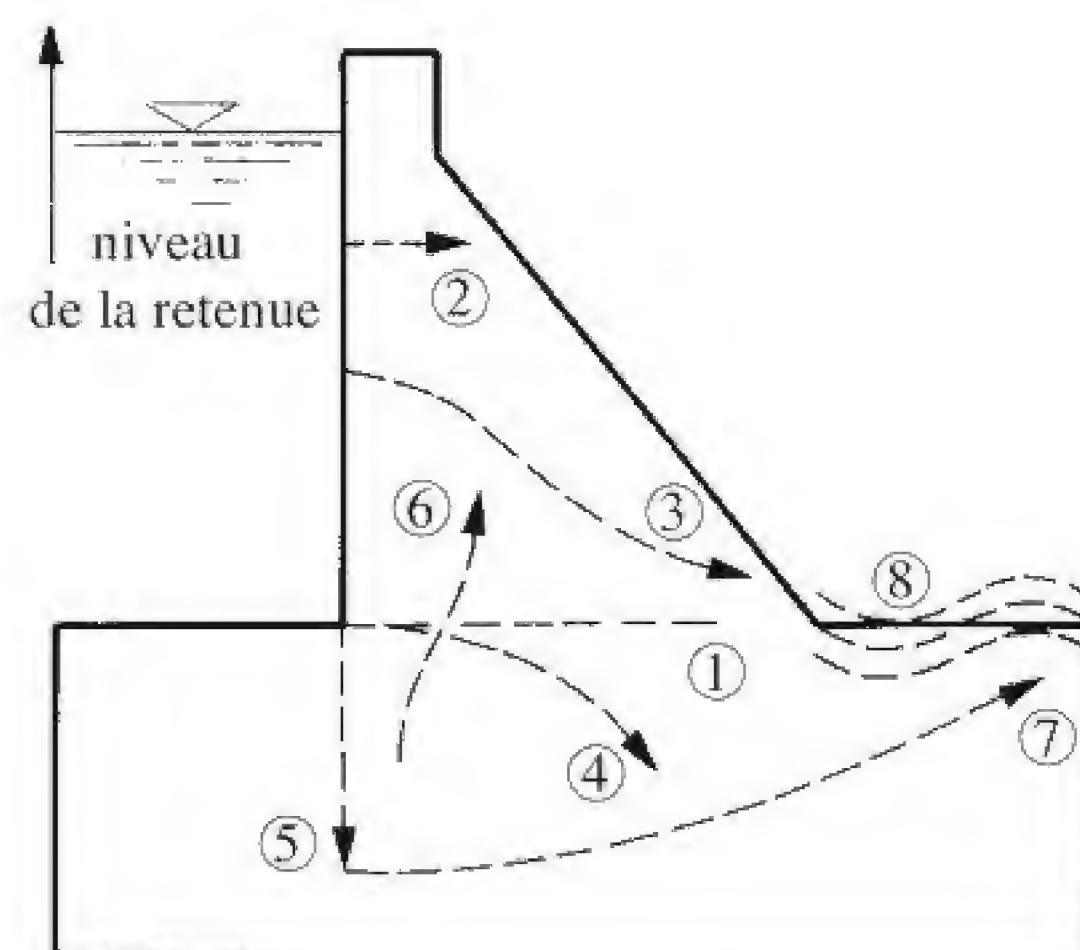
Mécanisme de rupture d'un barrage-poids (①, ② fissures horizontales, ③, ④ fissures curvilignes, ⑤ fissure verticale dans la fondation, ⑥ extension dans le barrage de discontinuité de la fondation, ⑦ surface de glissement en fondation, ⑧ instabilité par flambage de couches minces. Source : Martin Leclerc, Pierre Léger, René Tinawi, Manuel d'utilisation « CADAM ».
